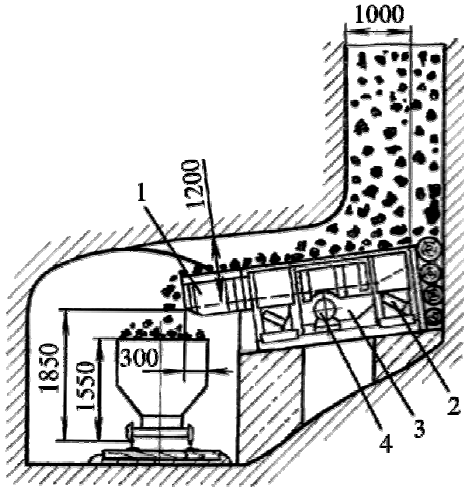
Схематический вид вибролюка 1АШЛ: 1 – грузонесущий орган; 2 – амортизирующие опоры; 3 – вибратор; 4 – электродвигатель
